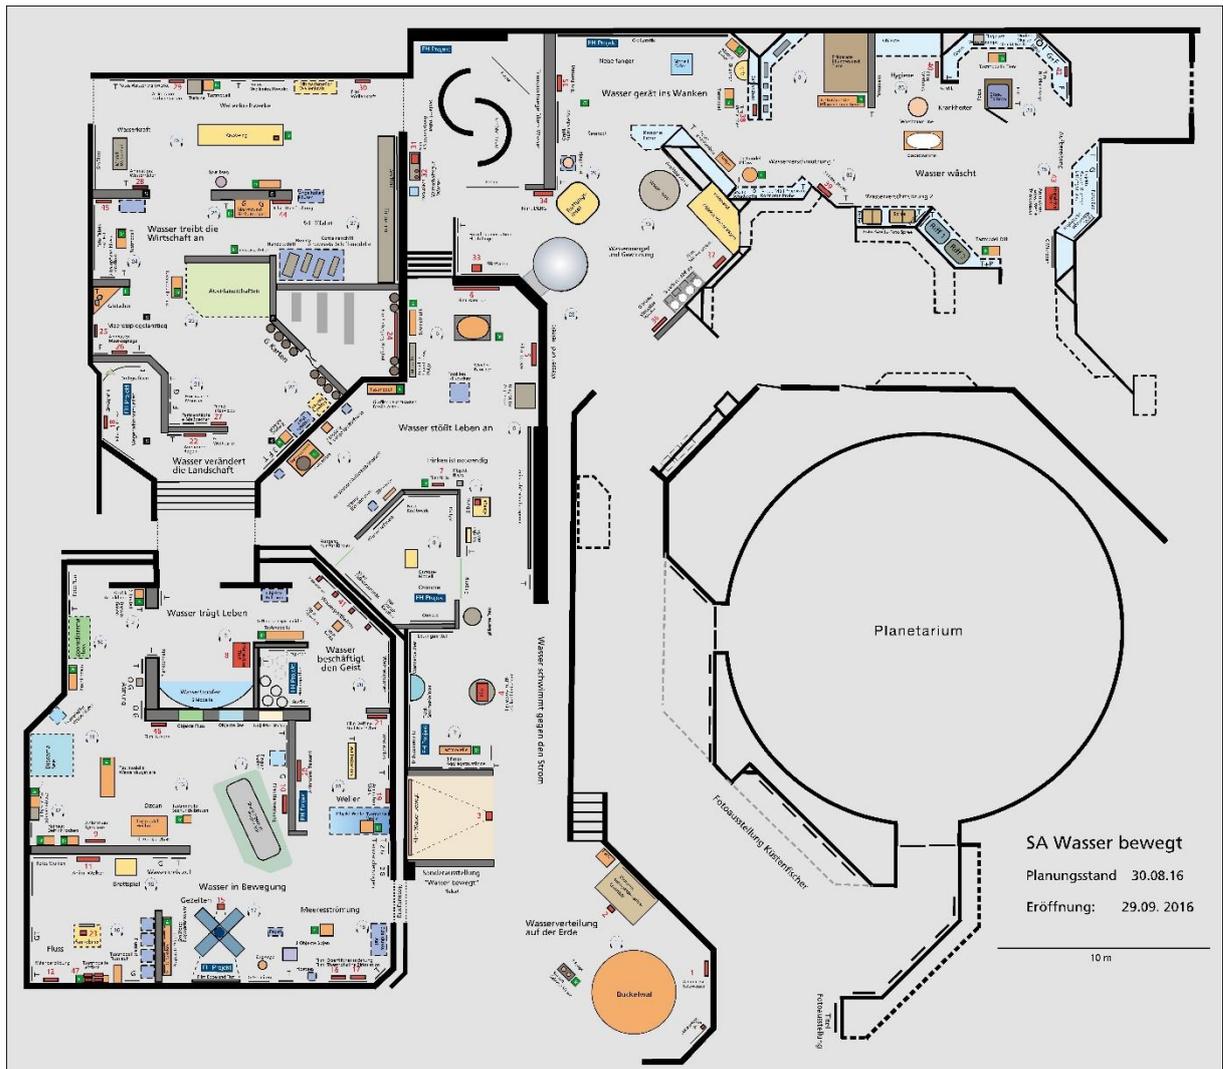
Grundriss Sonderausstellung *Wasser bewegt- Erde Mensch Natur* (Schleithoff, 2016)
